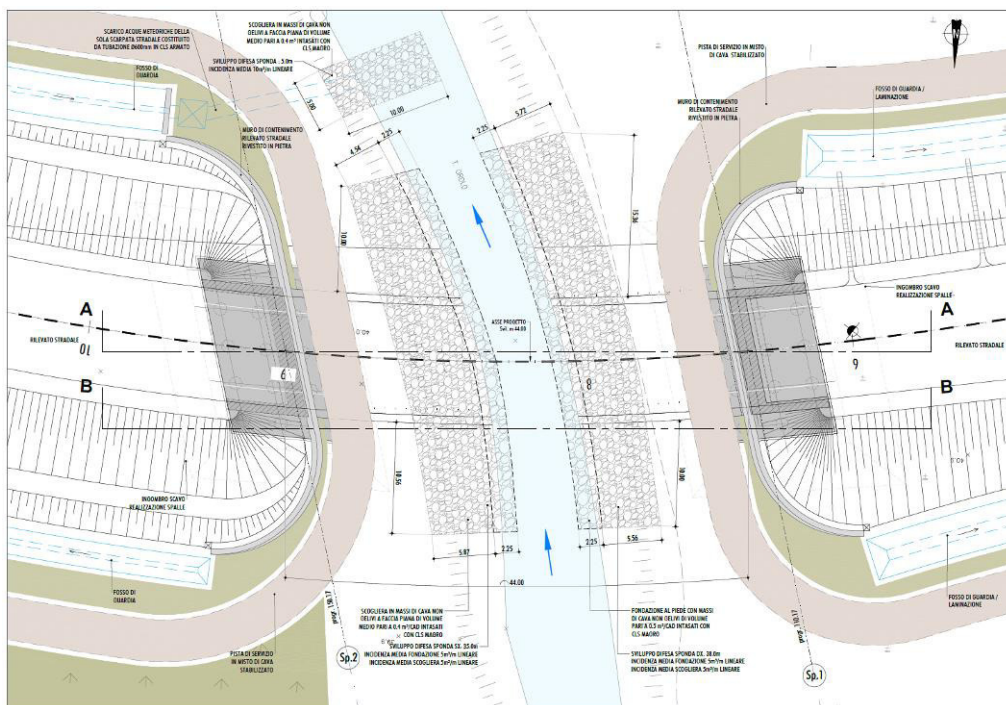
TORRENTE OROLO: PLANIMETRIA NELL'INTORNO DEL PONTE DI PROGETTO
